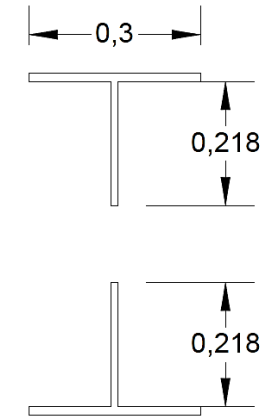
Sección transversal clase 4 de las vigas de piso en voladizo a compresión. Elaboración propia con AutoCAD.
